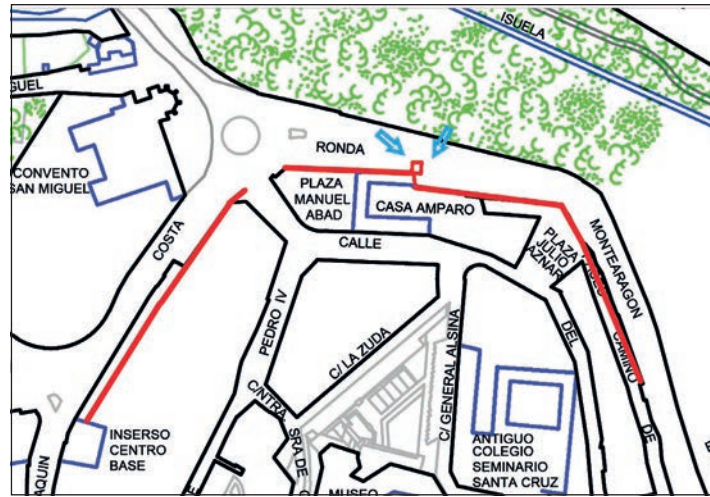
Plano de situación del torreón de la Casa Amparo, en una posición central del sector norte de la muralla.
